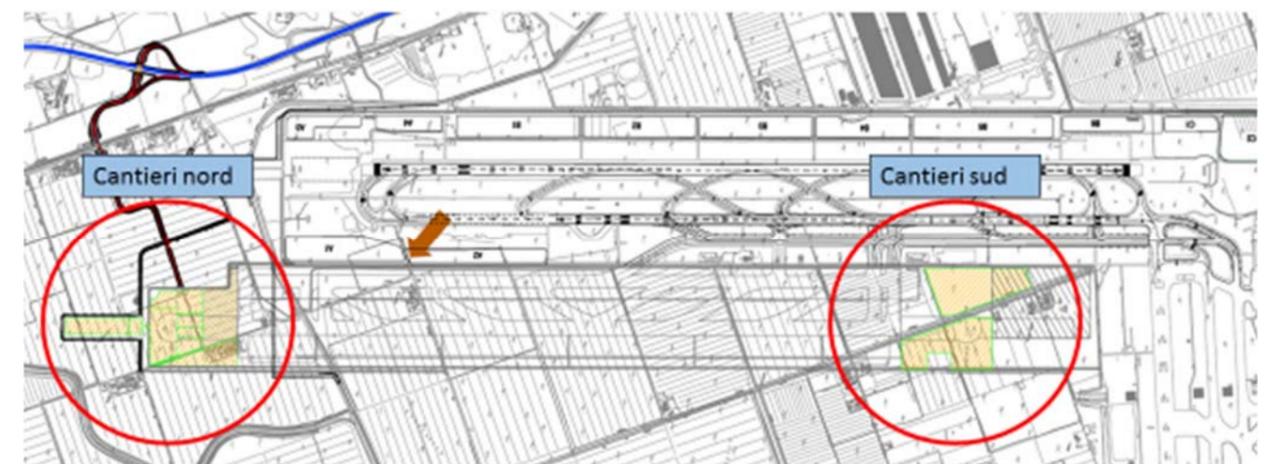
Planimetria con le aree di cantiere di Pista 4
